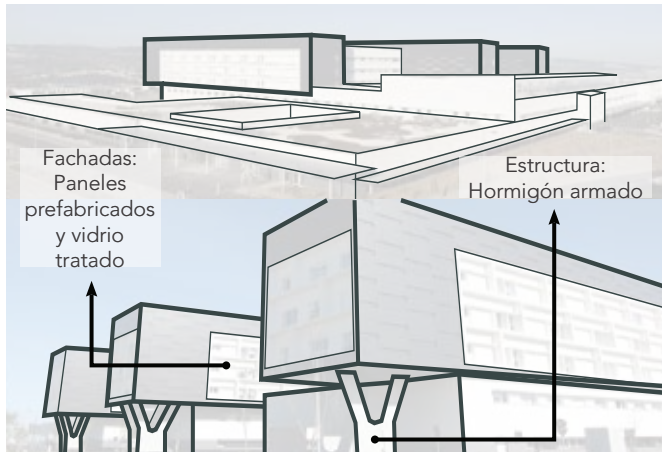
D01 - Detalle Interpretativo de Fachada y Aislamiento Térmico basado en Hospital Beatriz Ángelo.
